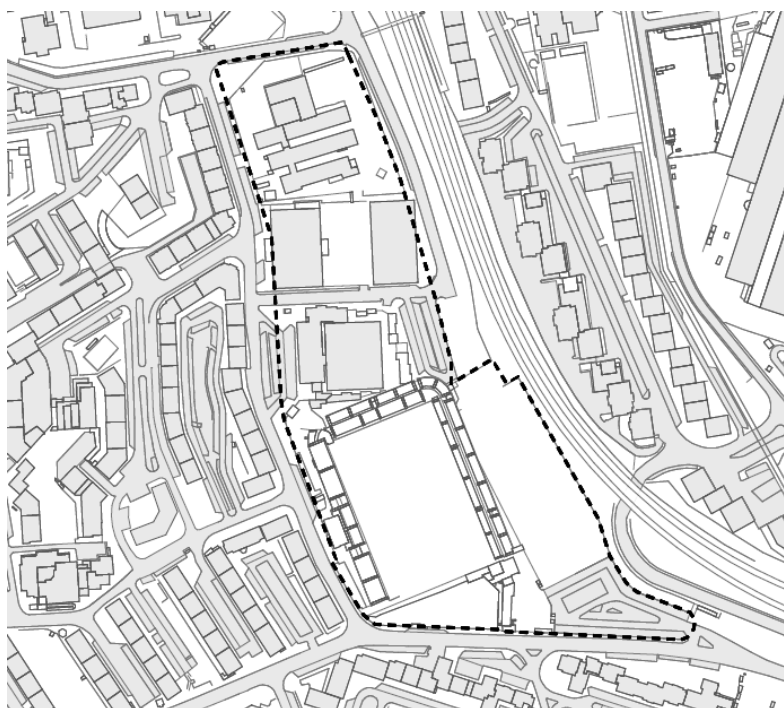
Planta da área de intervenção da Área Desportiva da Venteira (Imagens PROAP).
